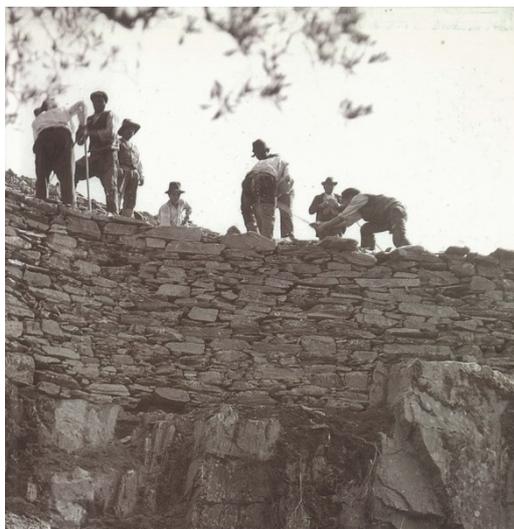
Fotografia da construção de muro de suporte em xisto [3]
